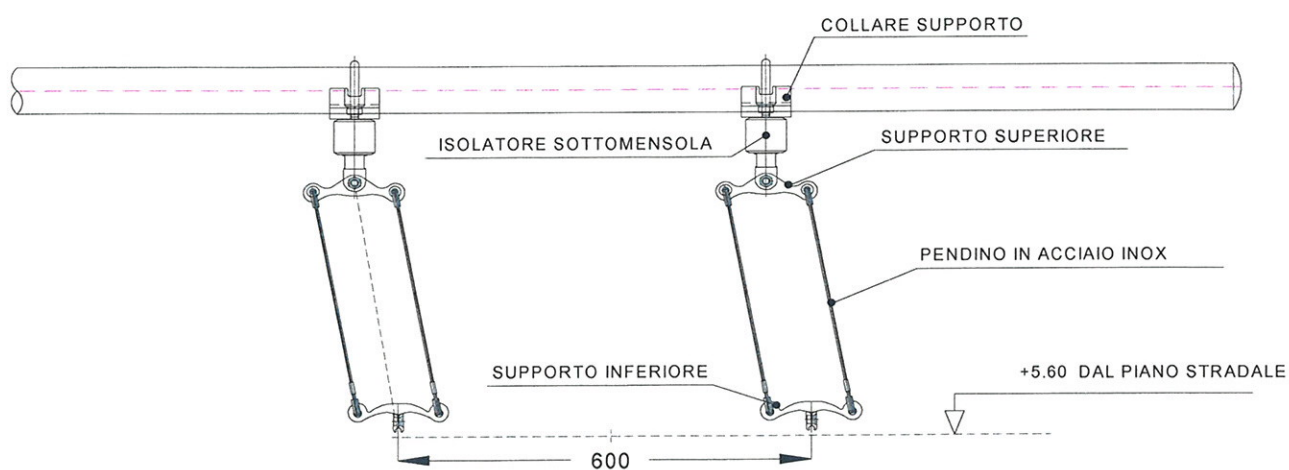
ASSIEME DI SOSPENSIONE A SEMPLICE BIFILARE DI RETTILINEO
